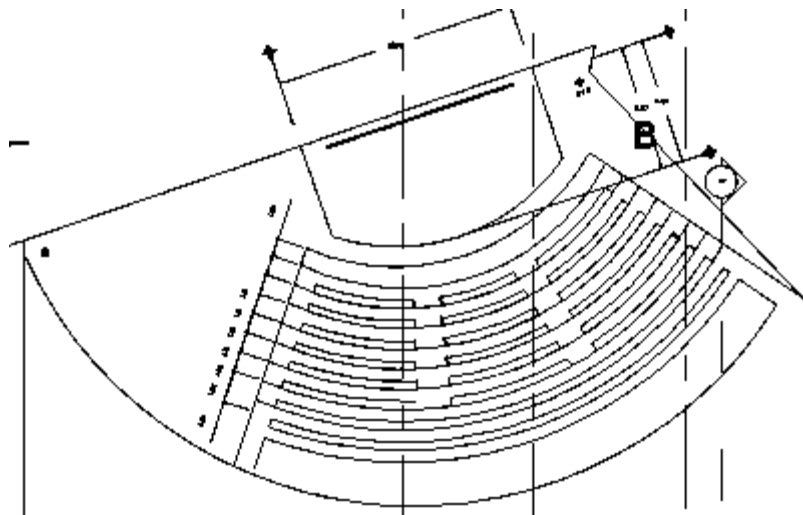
area de estudio. Fuente: Plano arquitectónico del proyecto
